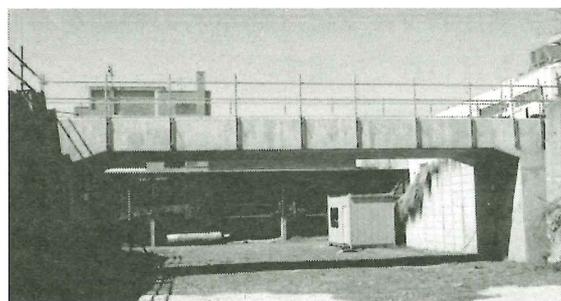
ジオシンセティックス補強土一体橋梁試験施工
